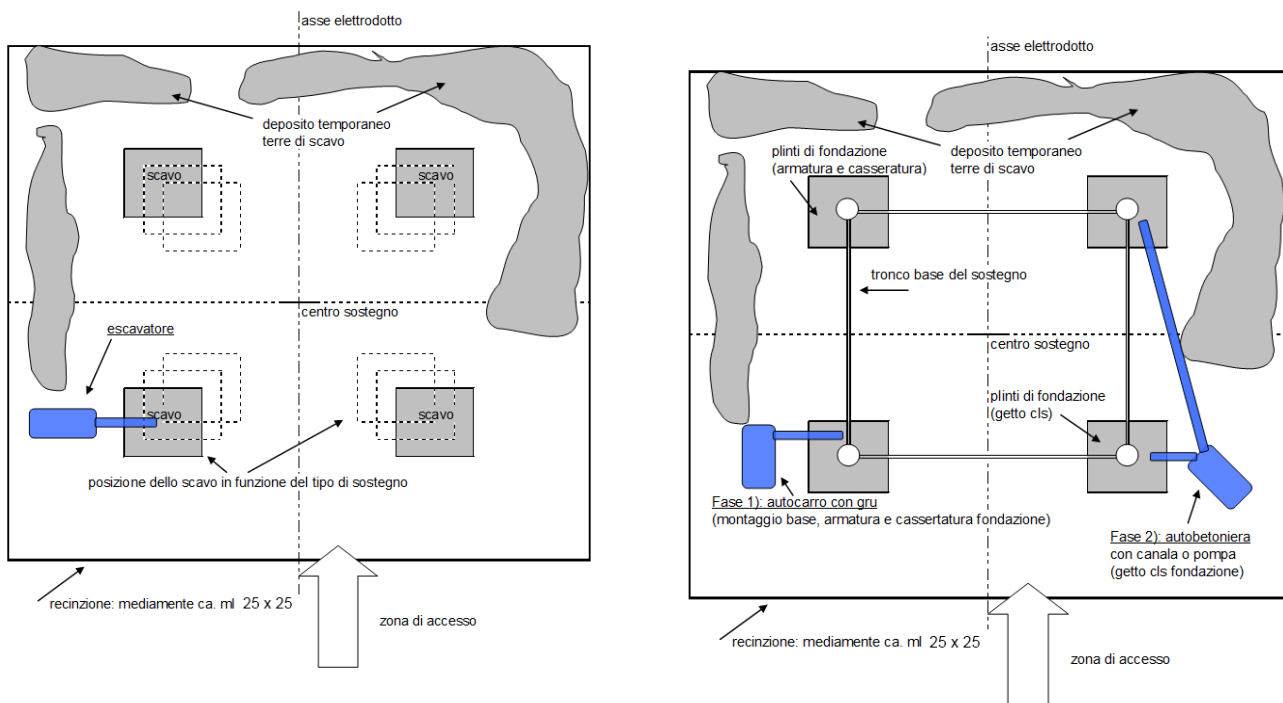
Planimetria dell'Area Sostegno (scavo di fondazione - getto e basi), tipologico
